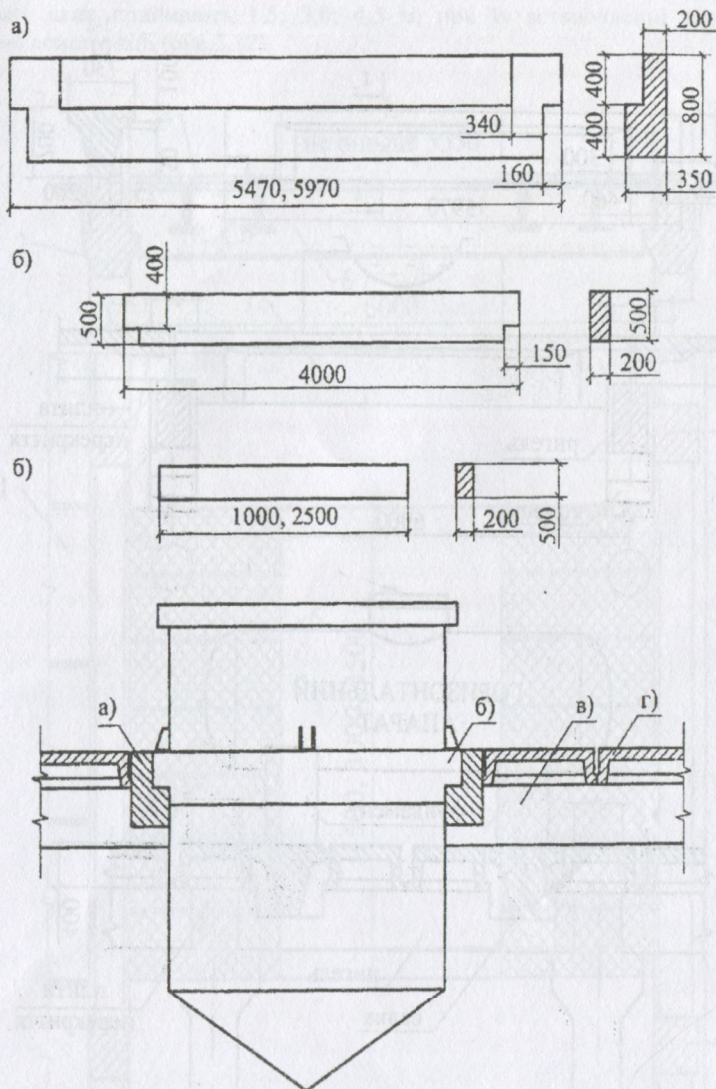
Кріплення "провислого" апарата: а – головна балка; б – другорядна балка; в – ригель; г – плити перекриття
